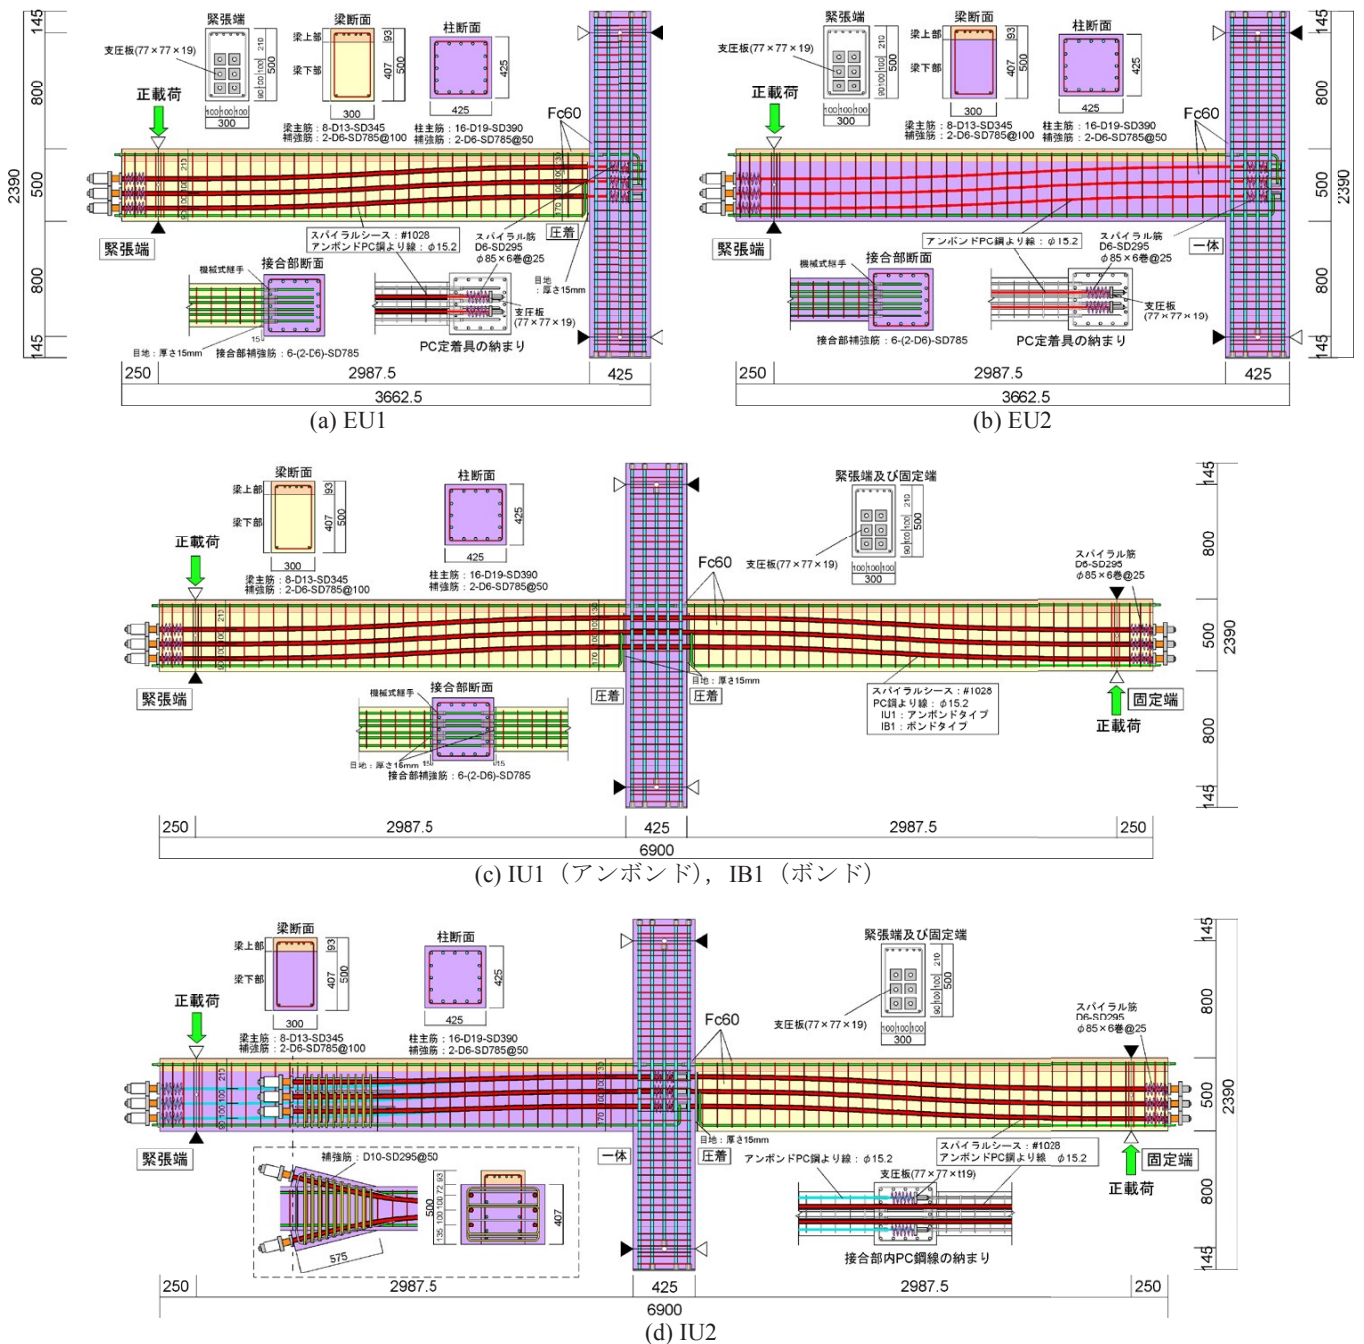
試験体形状及び配筋 (Arrangement of the Specimens)
